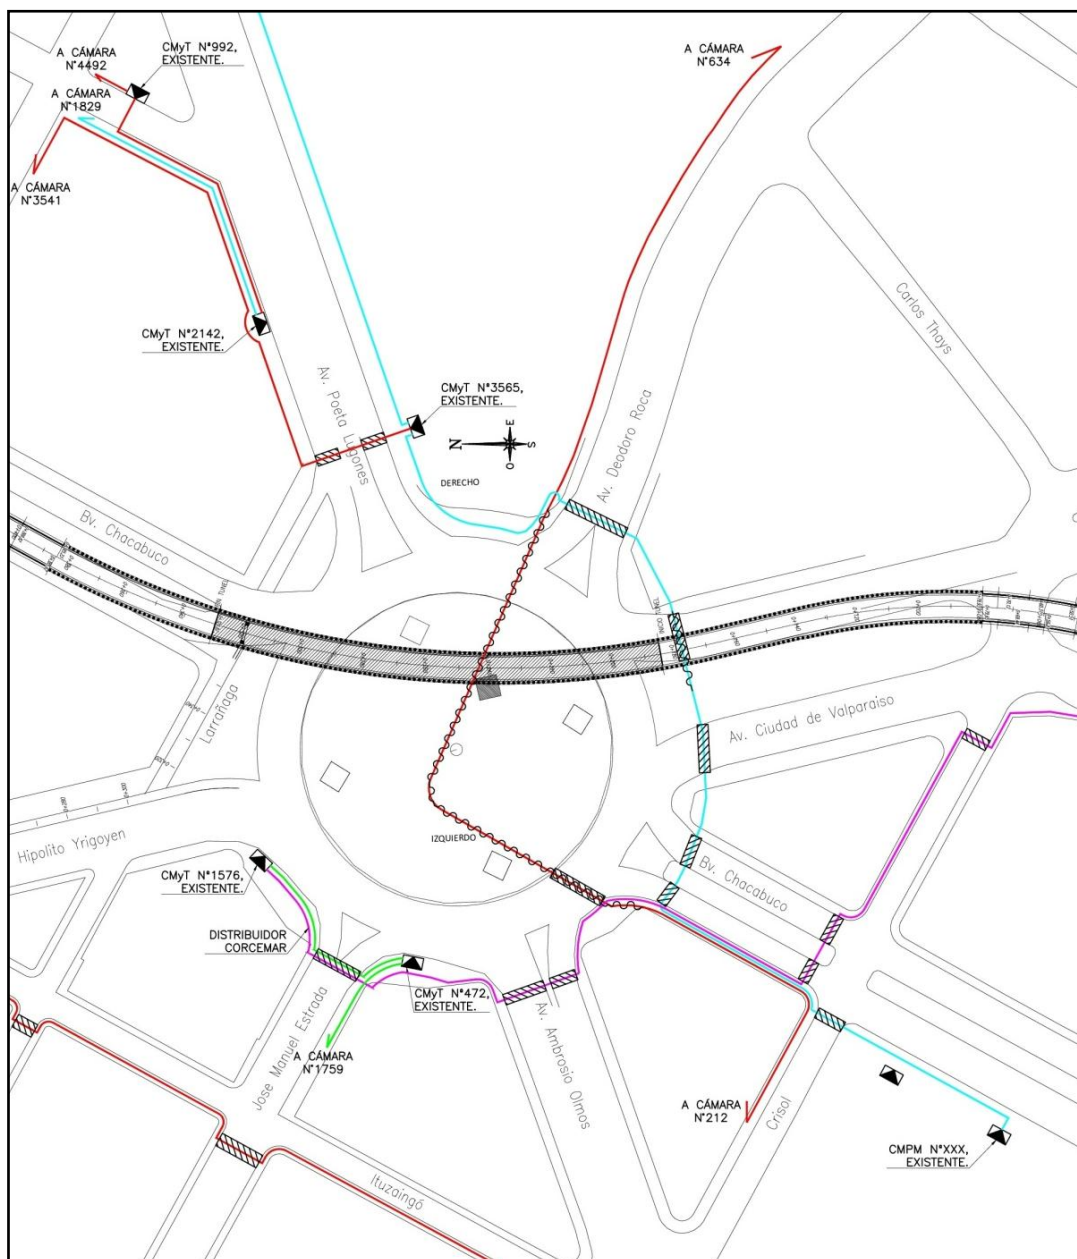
Planimetría con líneas existentes de media tensión (plano N°13).
